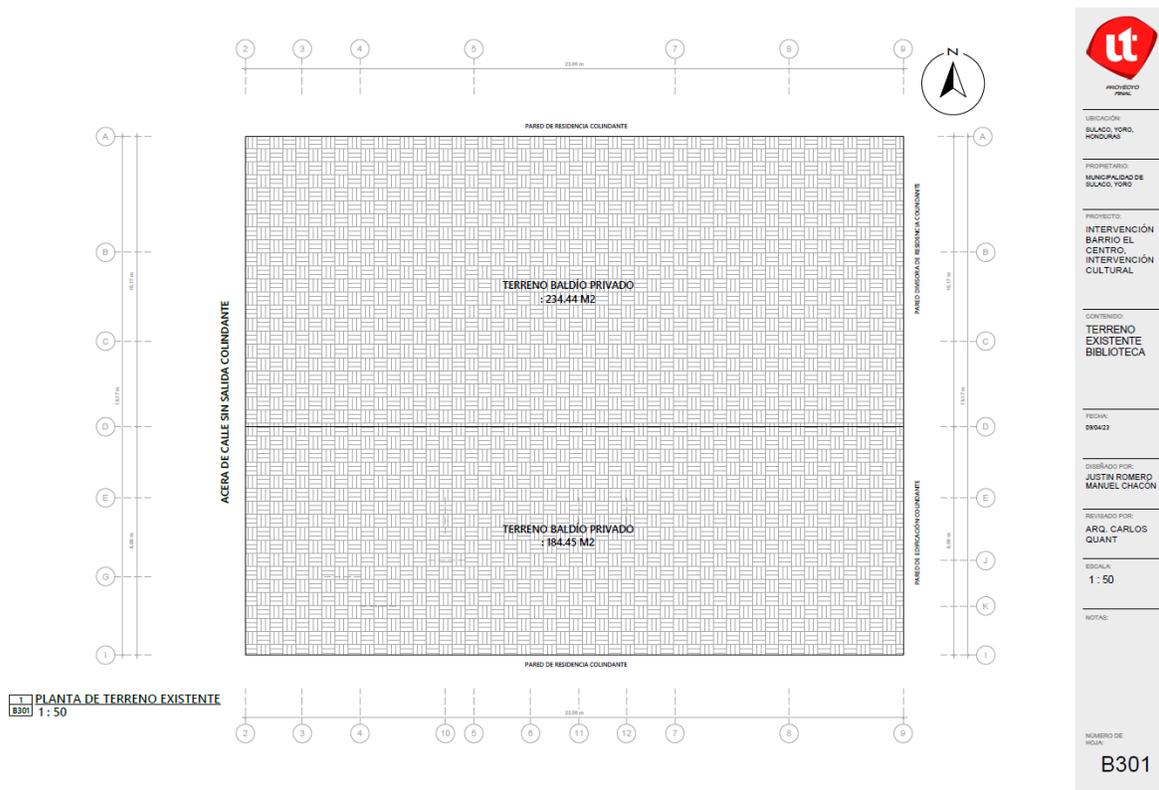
Planta de Terreno Existente | Fuente: Elaboración Propia
